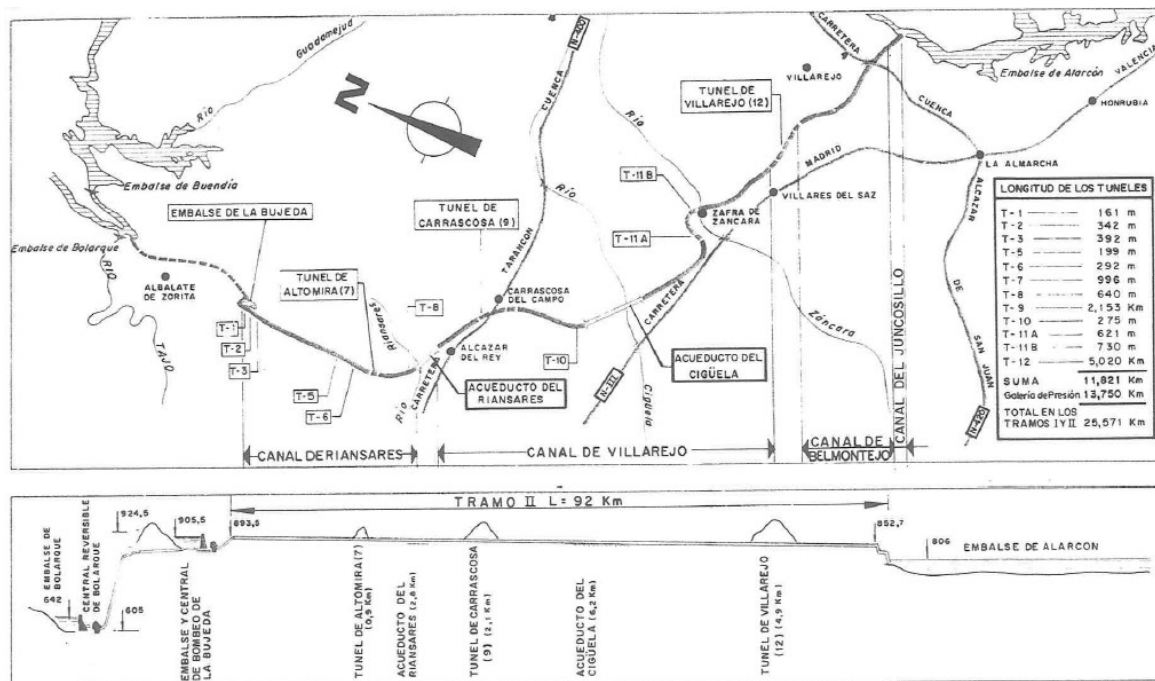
Planta y perfil longitudinal del Tramo II del canal ATS.
